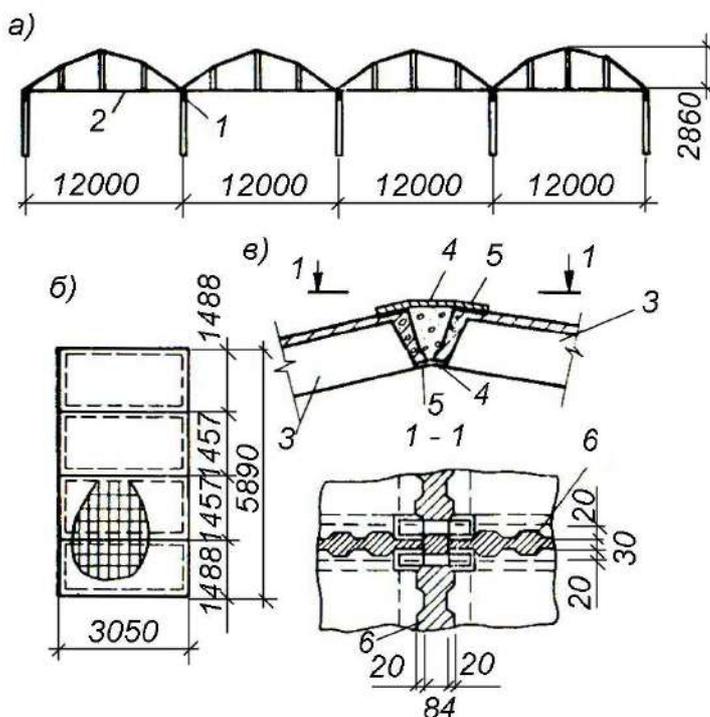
Складка из плоских сборных железобетонных элементов:
